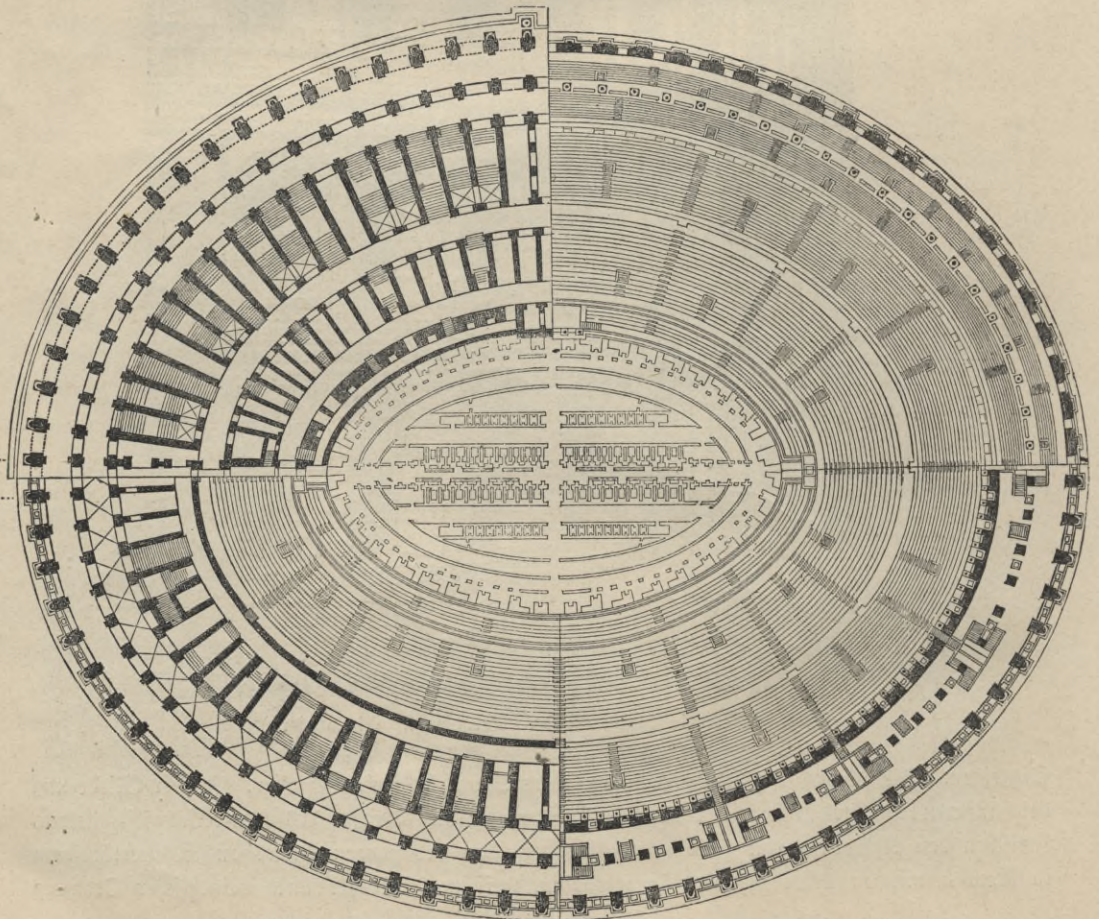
Kolosseum in Rom. Grundriß der vier Stockwerke.
